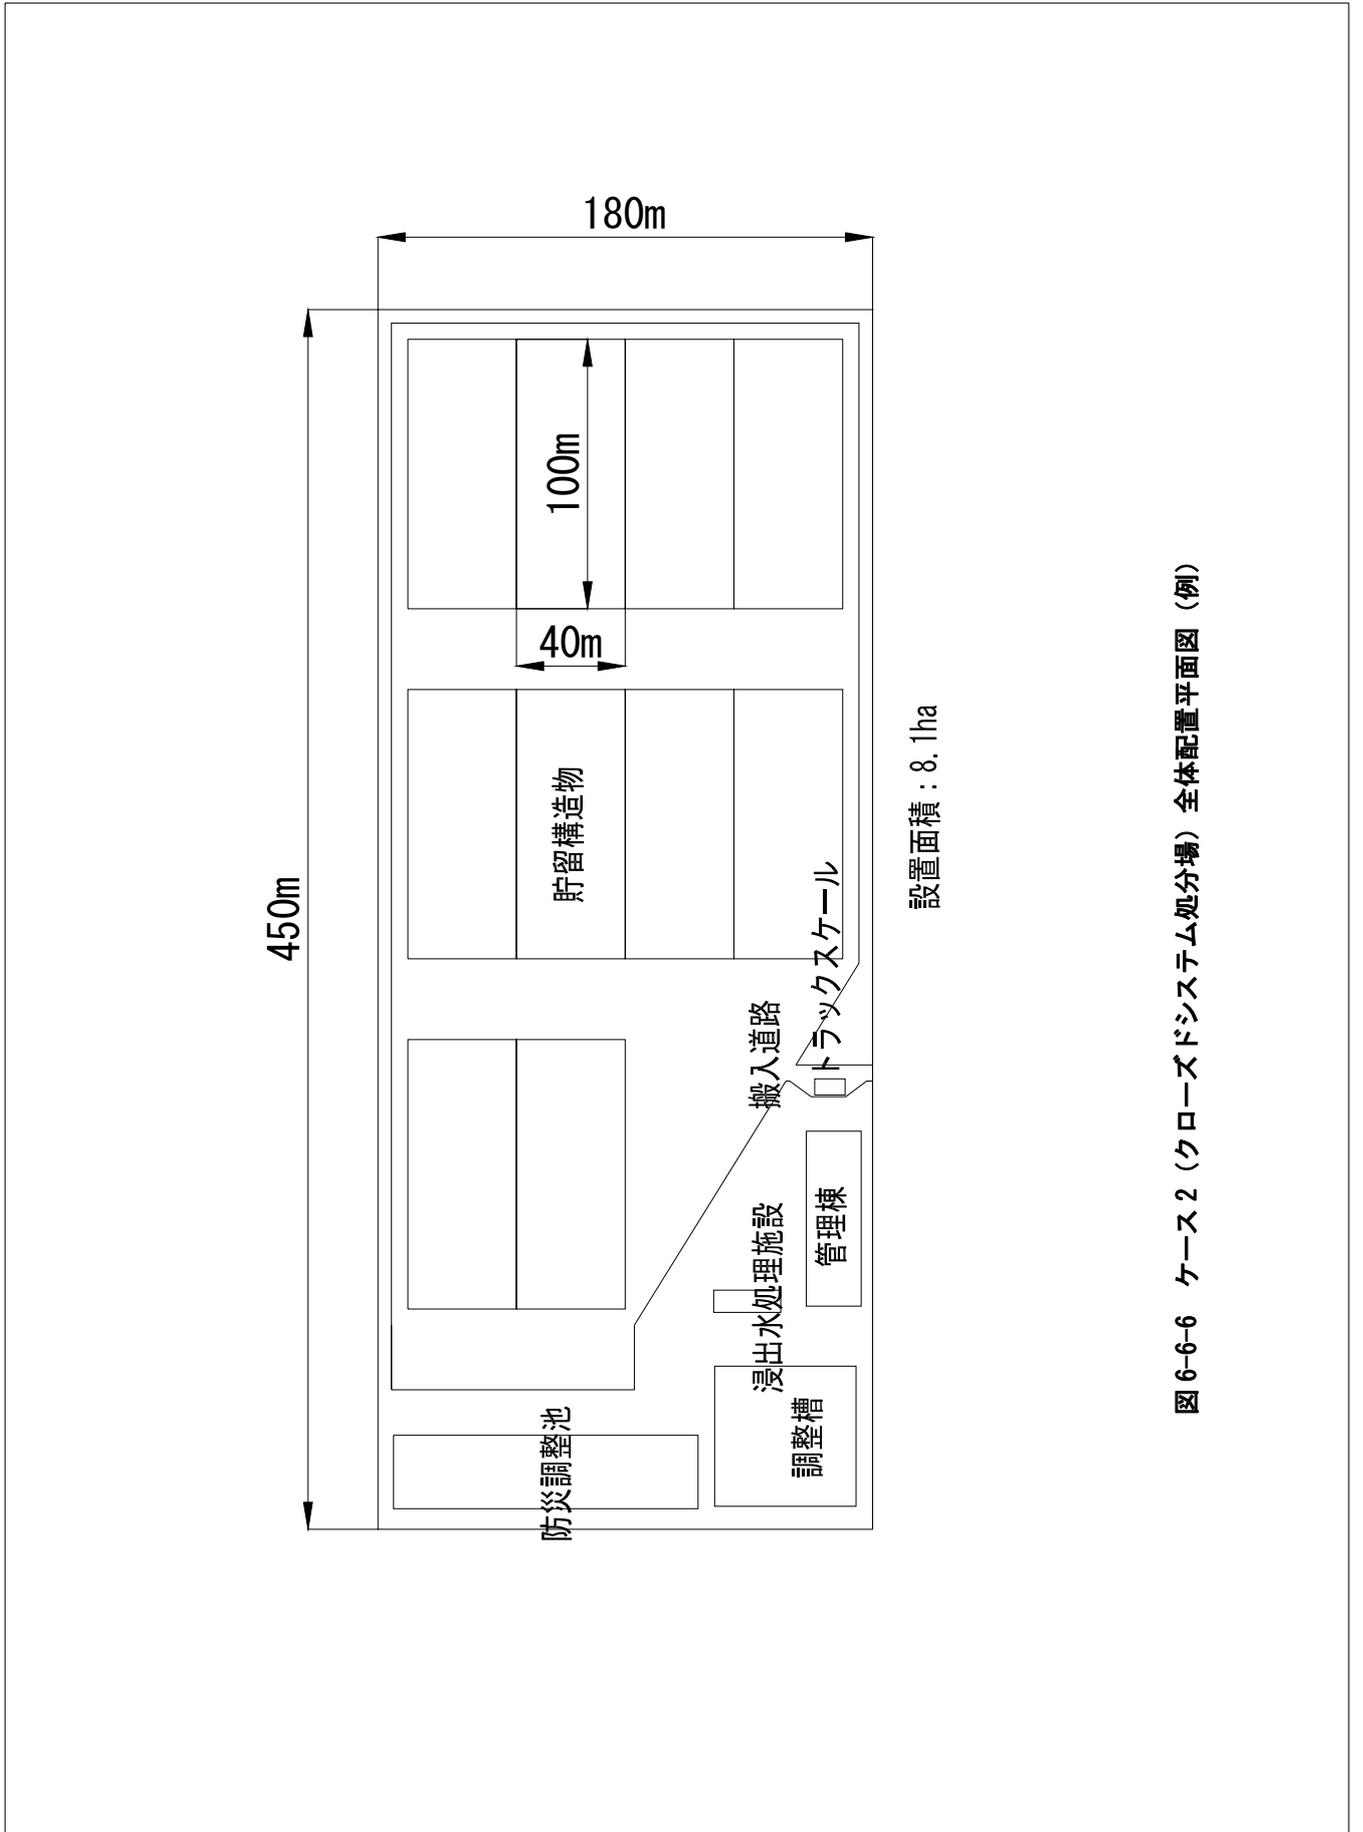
ケース 2 (クロスシステム処分場) 全体配置平面図 (例)
